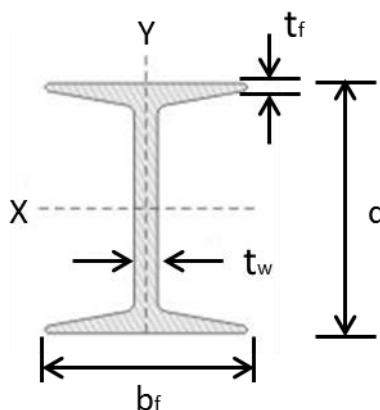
Dimensões do perfil I utilizado (GERDAL.2016).
